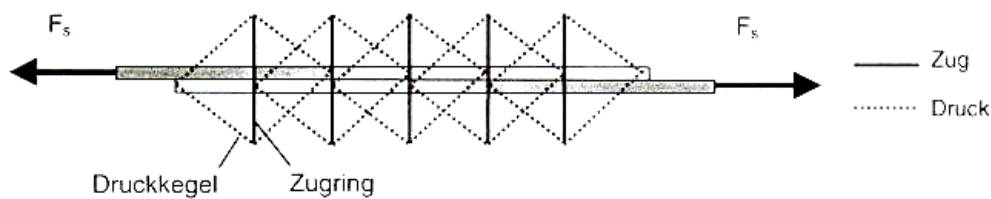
Lokales Fachwerk 2 von gestoßenen Bewehrungsstäben (Burkhardt (2000))
